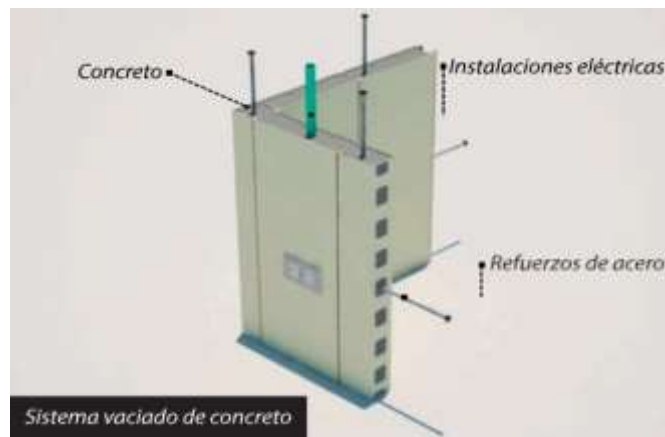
Detalles del sistema de vaciado del concreto en paredes. Fuente: <https://azembla.com>
